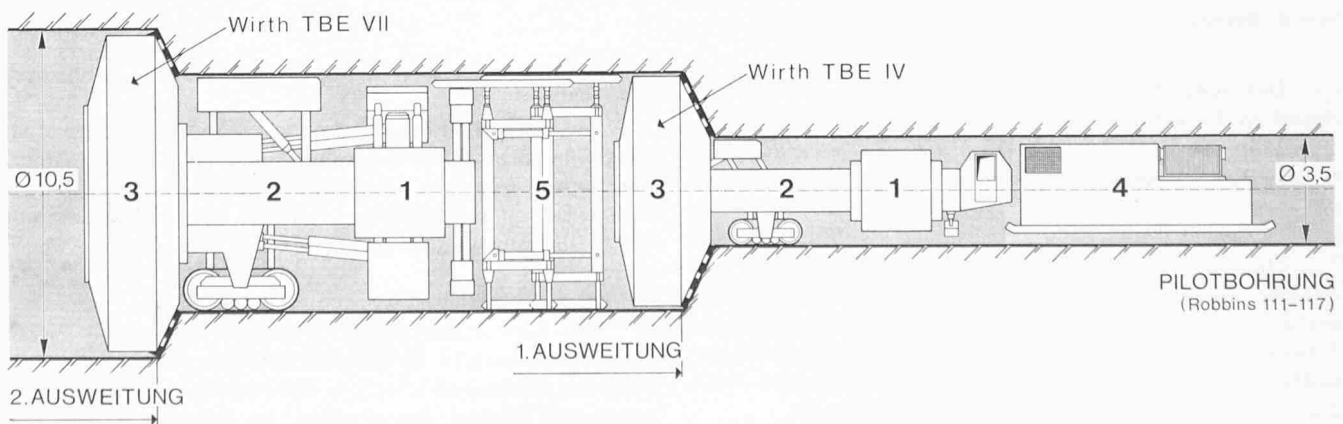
Schema der Tunnelvortriebsmaschinen. 1 Spannvorrichtung, 2 Führungsvorrichtung, 3 Bohrkopf, 4 Antriebszentrale, 5 schreitender Einbau
